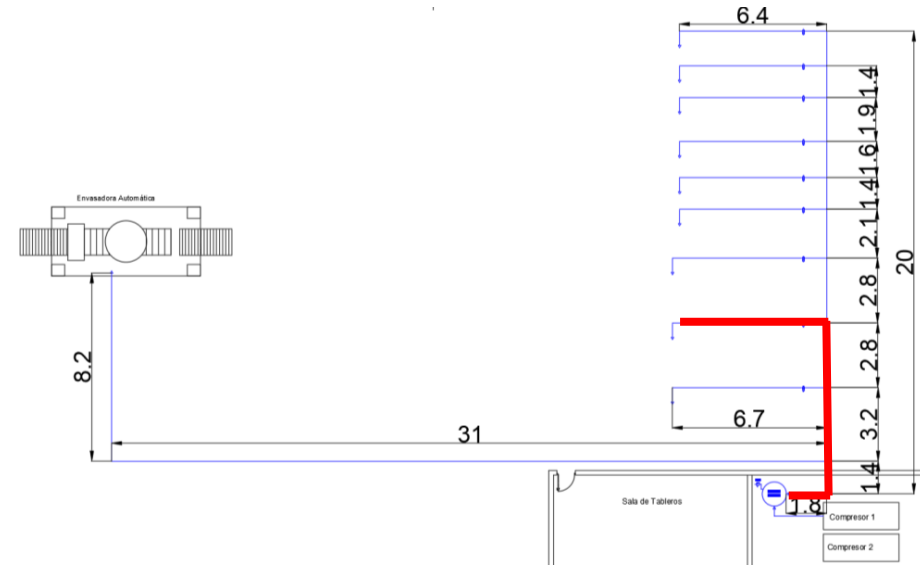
Layout verificación 4 de cañería de aire comprimido
